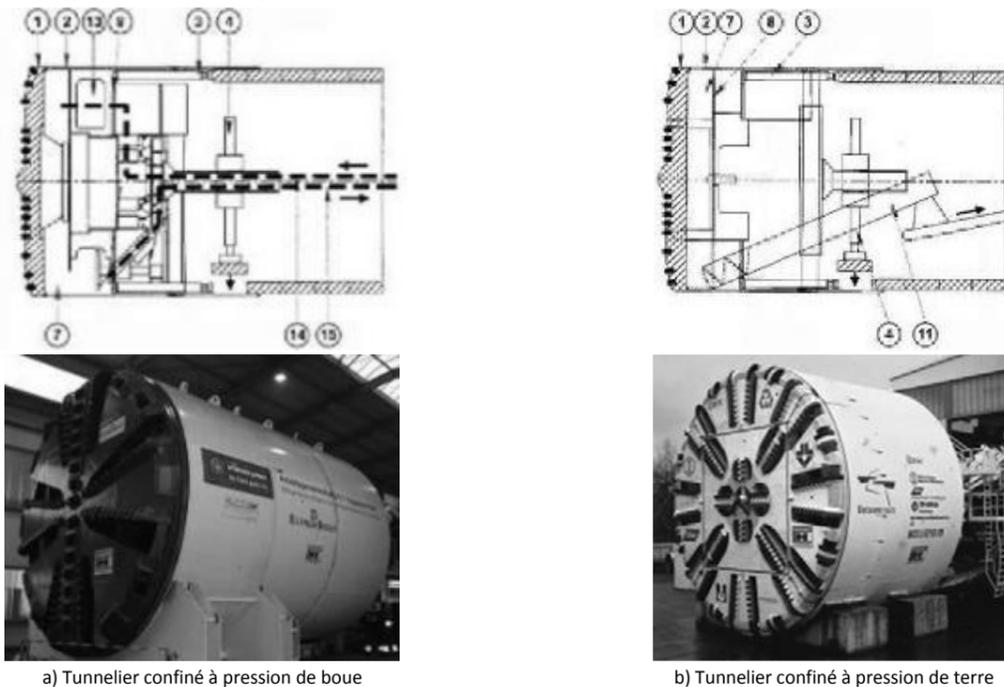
Principaux types de tunnelier à pression de confinement adaptée au LRF.
